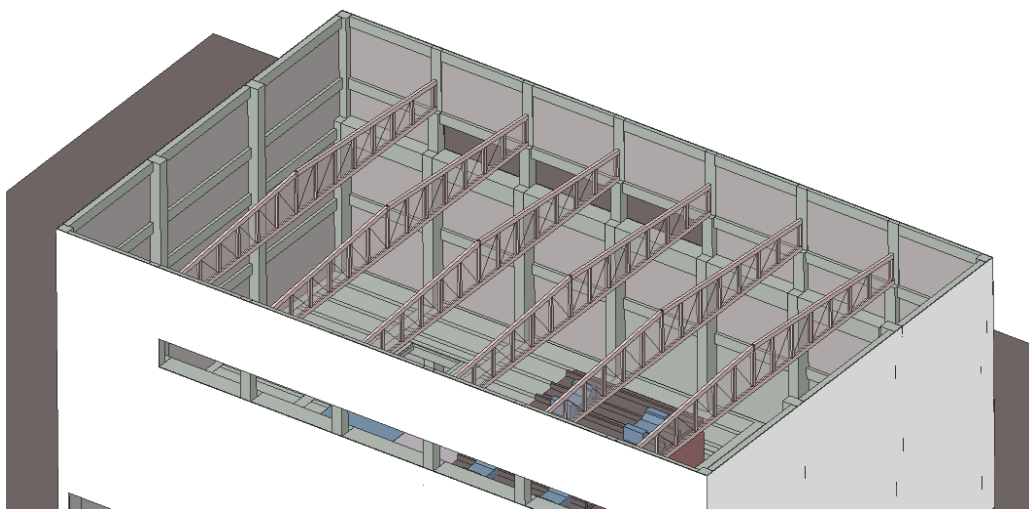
Cerchas metálicas de la Cubierta EAD.
